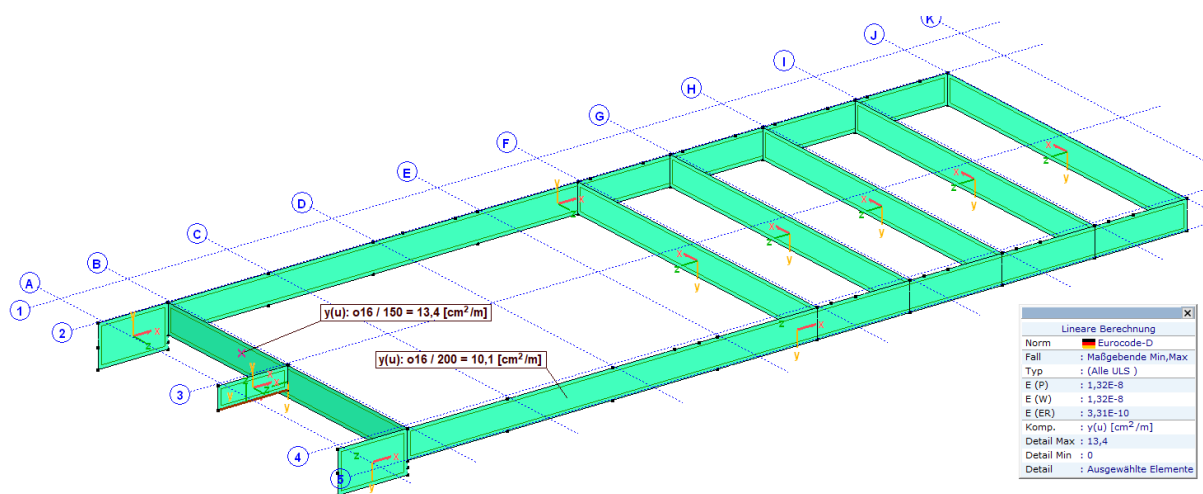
Entworfenere Bewehrung innen und außen in lokaler y-Richtung (vertikal)
